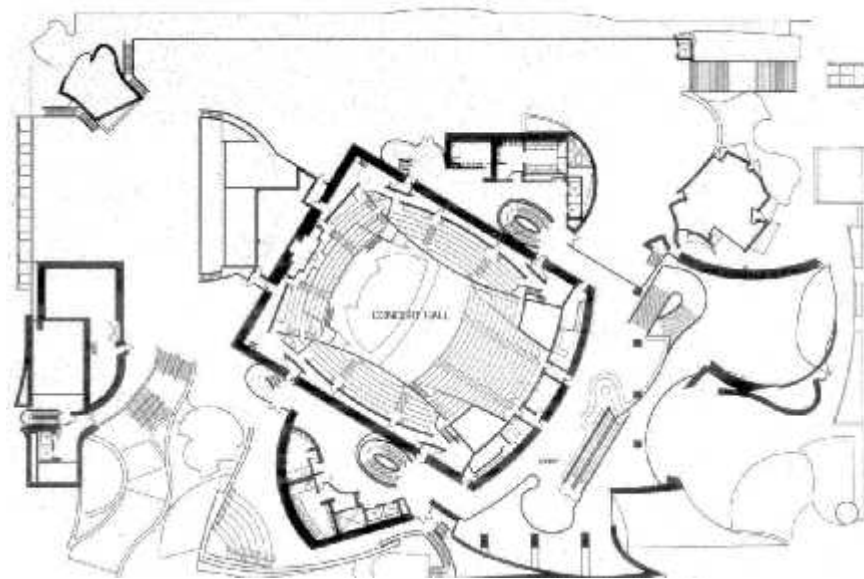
Garden level plan. En "AD Classics: Walt Disney Concert Hall / Frank Gehry", por R. Jones, 2013, <http://www.archdaily.com>. Derechos de autor [2013] por ArchDaily. Reimpresión autorizada.
